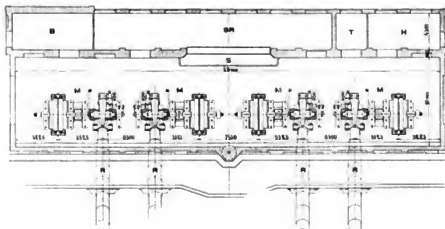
Grundriss des Maschinenhauses der Anlage Manojlovac.
